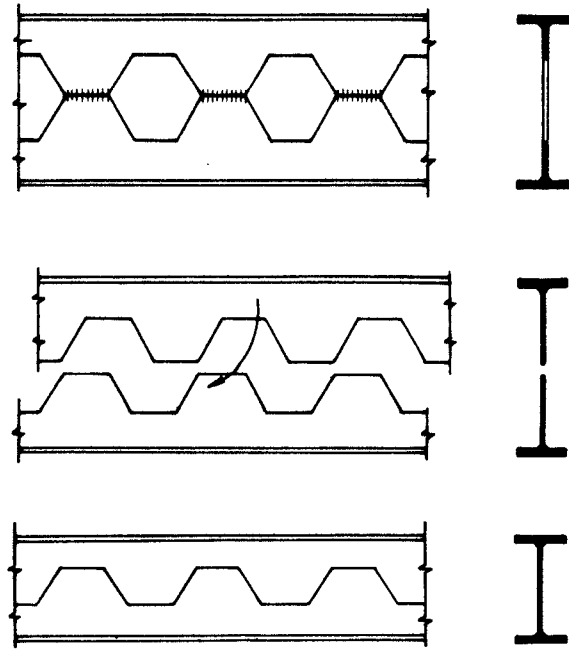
Vigas Castelo, Alveolar ou Comeia [2]
